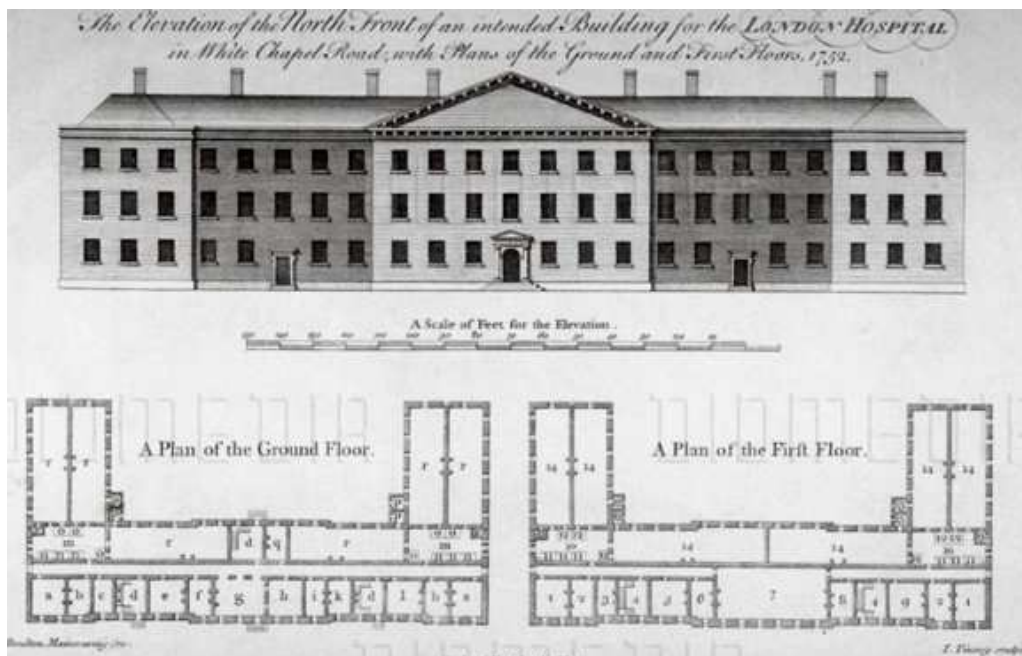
Elevação e plantas do térreo (abaixo, esquerda) e do primeiro piso do London Hospital. Fonte:
